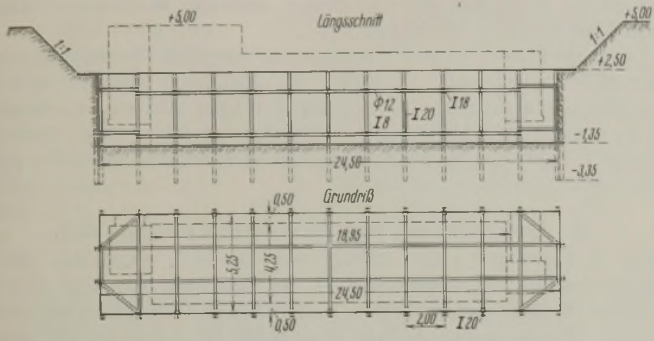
a. u. b. Baugrube des Pumpenkellers.
